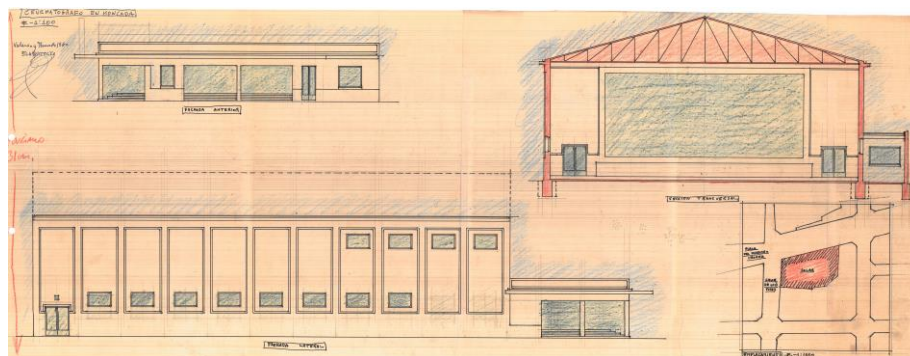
Lámina que incluye la fachada principal, fachada lateral, sección transversal y emplazamiento
